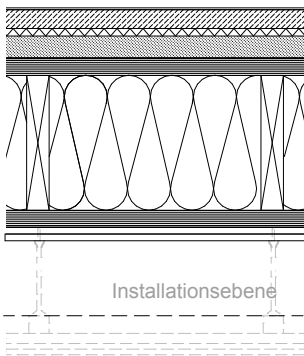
Übersicht betrachtete Bauteile Labor Geschossdecke
